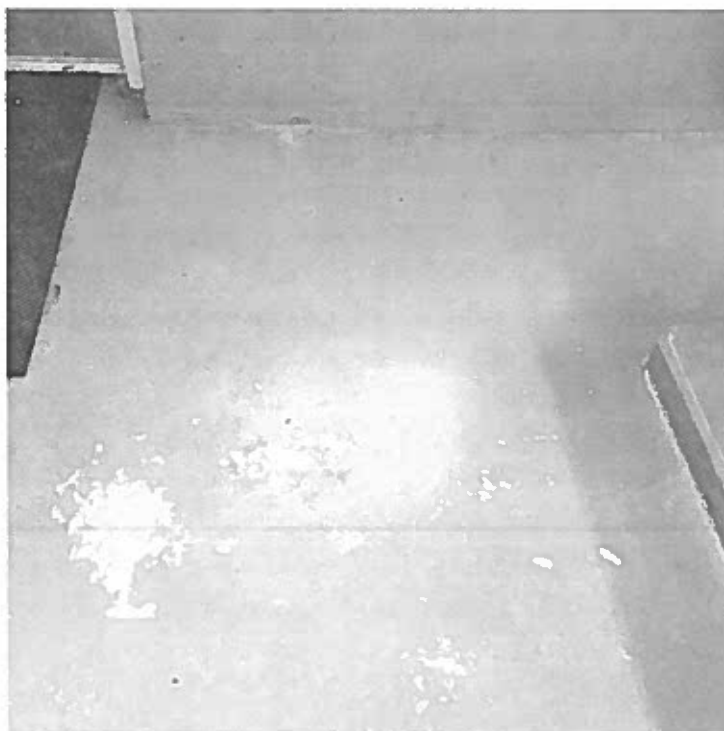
Plancher et mur de béton recouvert d'une peinture grise foncée
